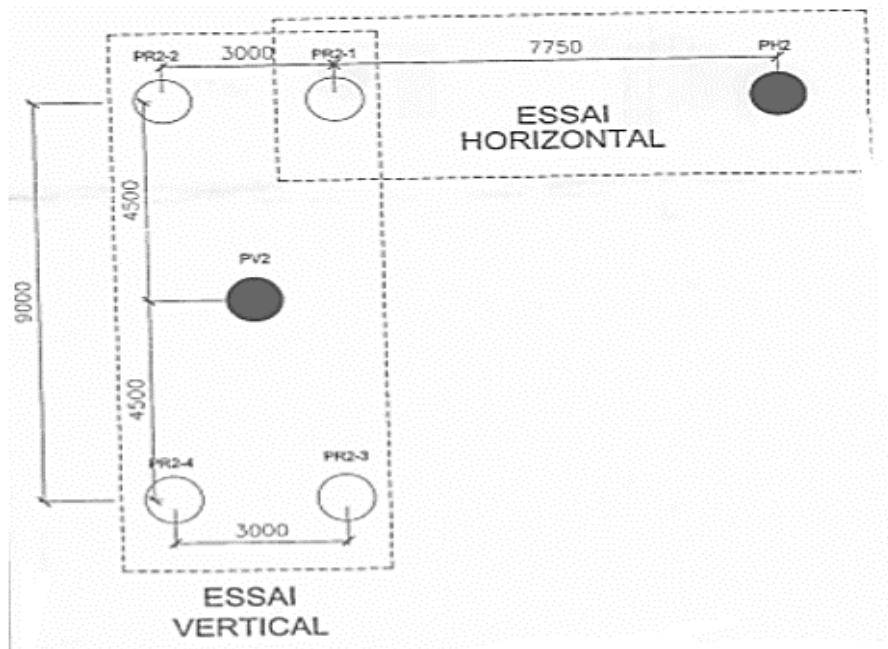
vue en plan de pieu d'essai PV2-PH2.
